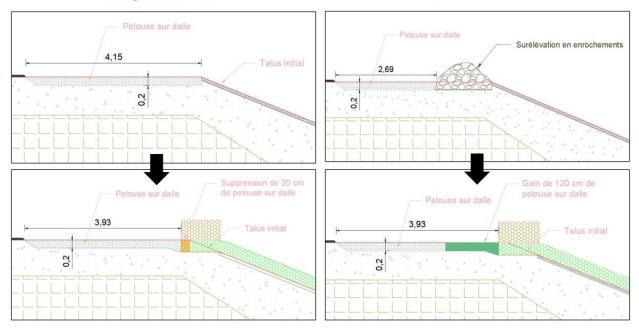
Impact des travaux sur l'habitat « pelouse calcicole sur dalle »
